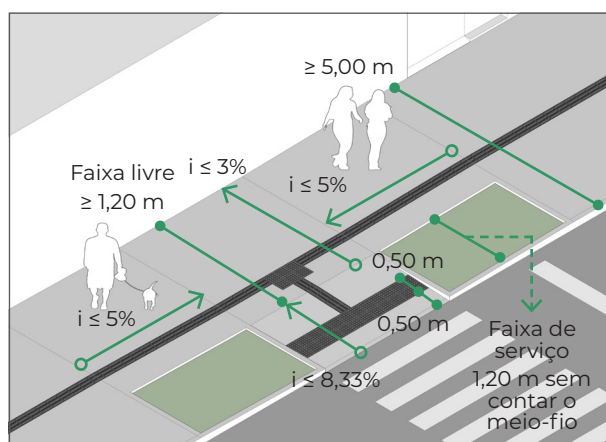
Rampa para travessia de pedestres entre canteiros em calçadas largas com patamar intermediário.
